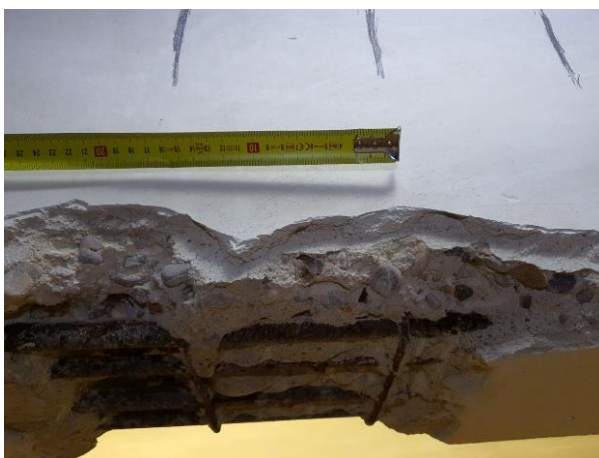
y 57 – Caracterización del armado de positivos de la viga.
